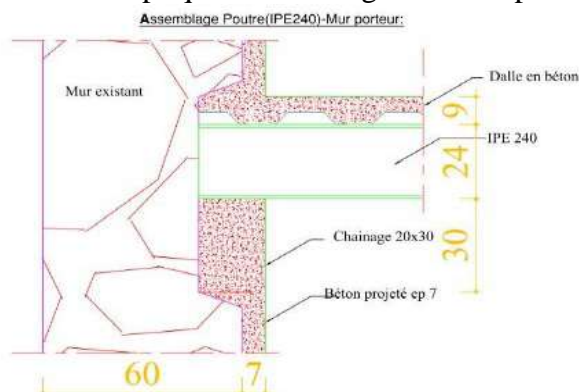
L'assemblage poutre IPE240-Mur porteur, source : dossier graphique béton et béton armé réalisée par l'ingénieur du BET
